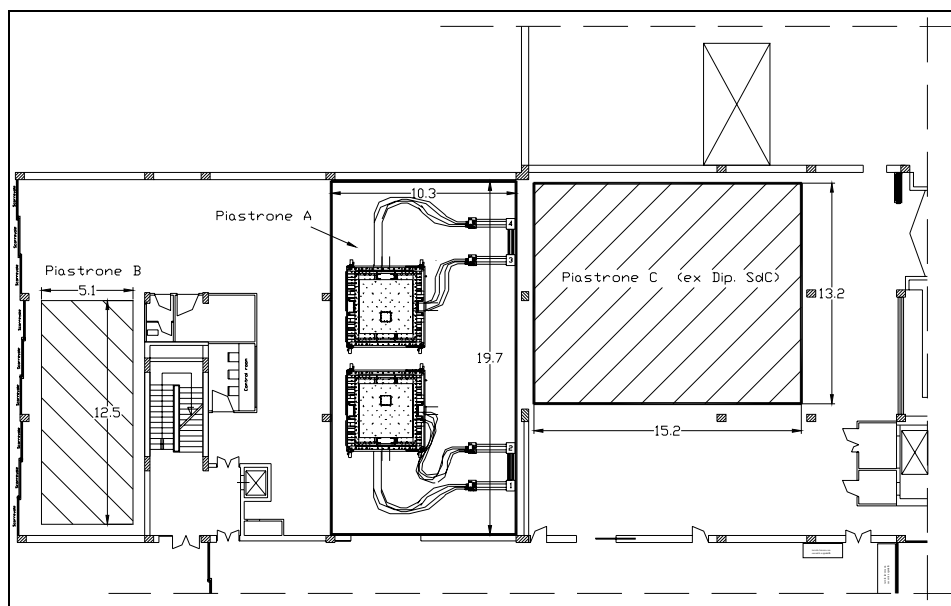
Pianta del piano terra del nuovo laboratorio del DIST
